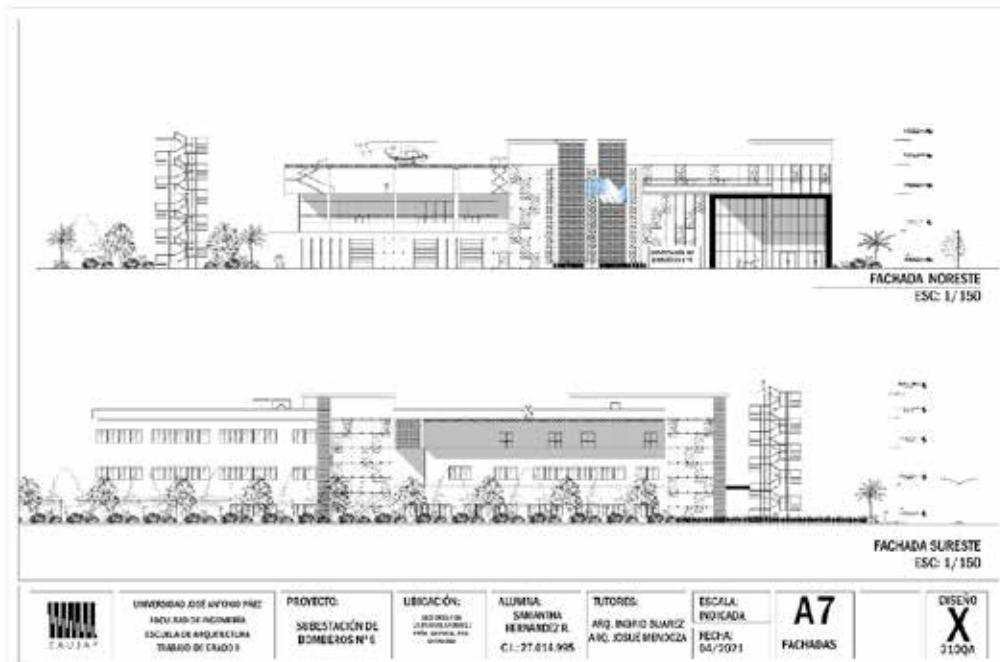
Fachadas A7. Fuente: La Autora (2021)
